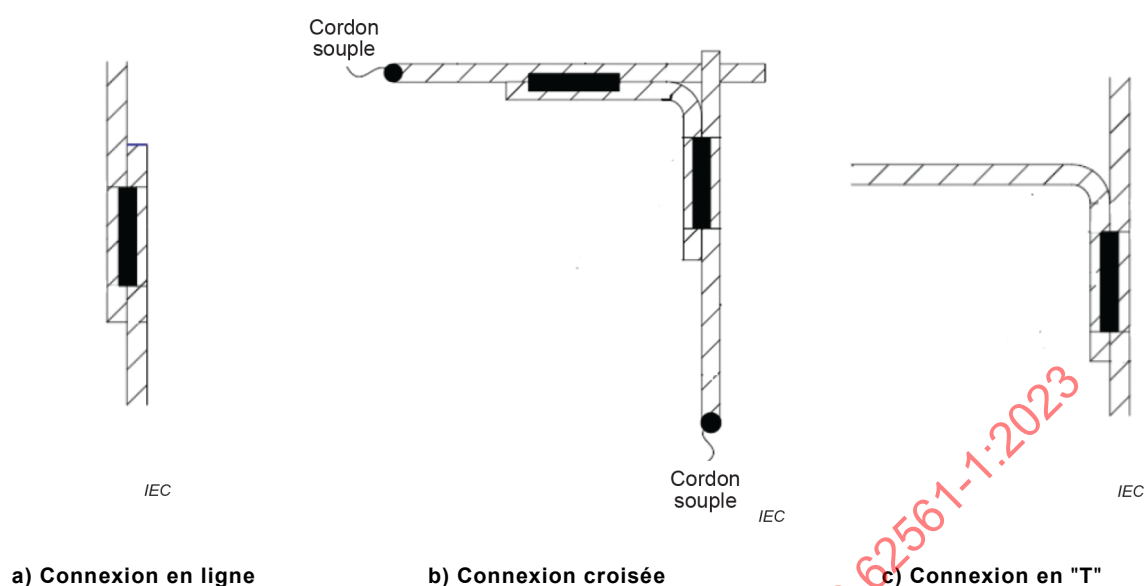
Montage de base des échantillons avec connexion par brasage, soudage ou soudure exothermique de tiges de renfort
